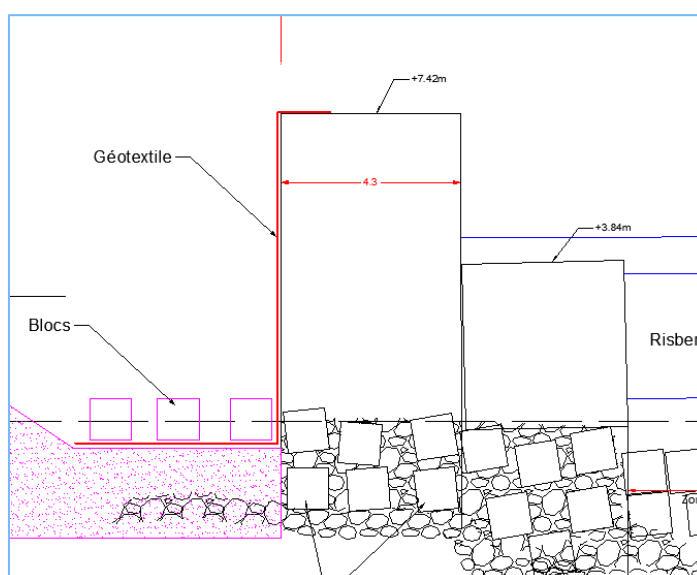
Plan de coupe des blocs stabilisateurs du géotextile
